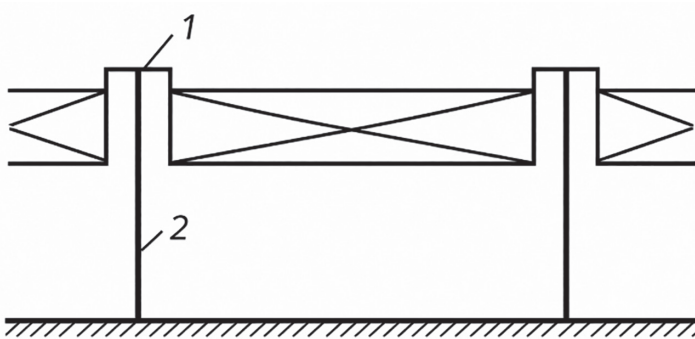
Corte de la pila 1 con juntas de deformación 2.
